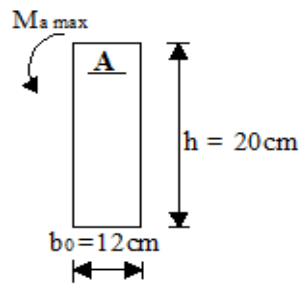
Coupe schématique de la poutrelle (appuis)
